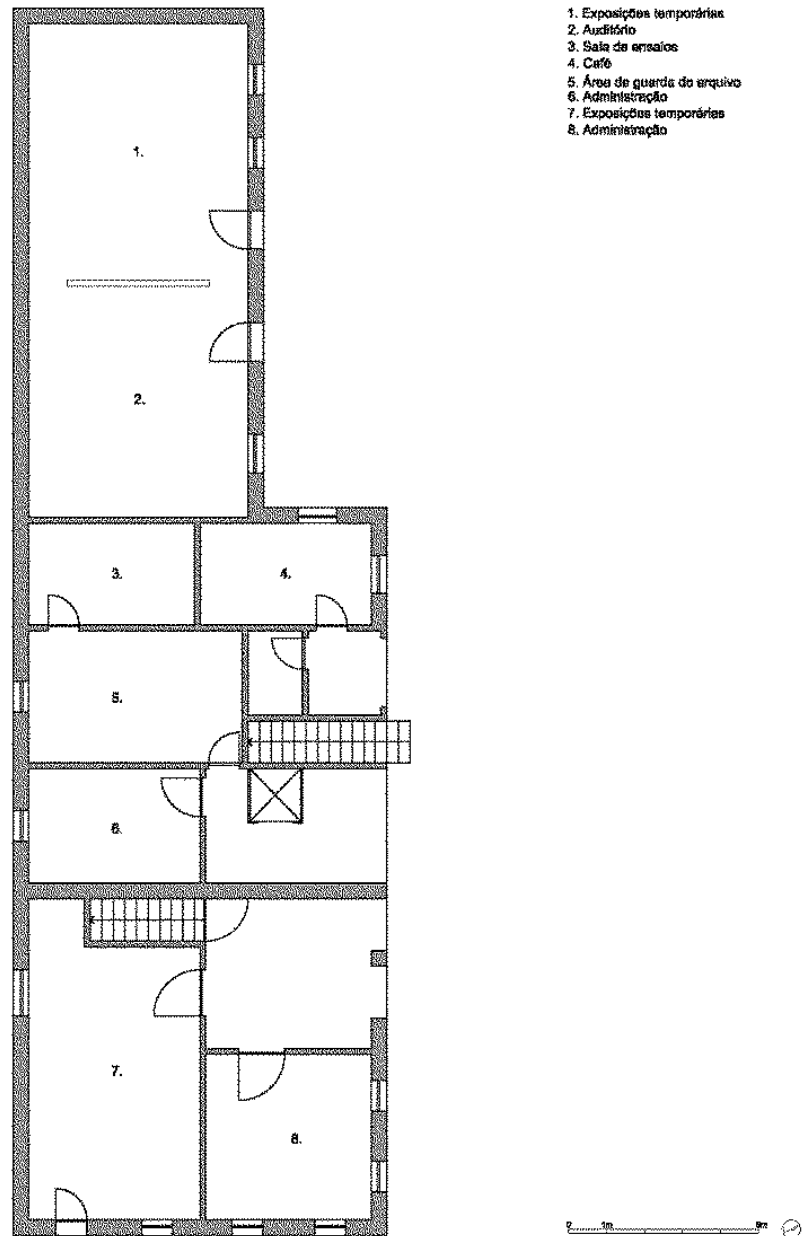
Planta baixa do pavimento inferior indicando onde está armazenado o acervo desde 2014.
